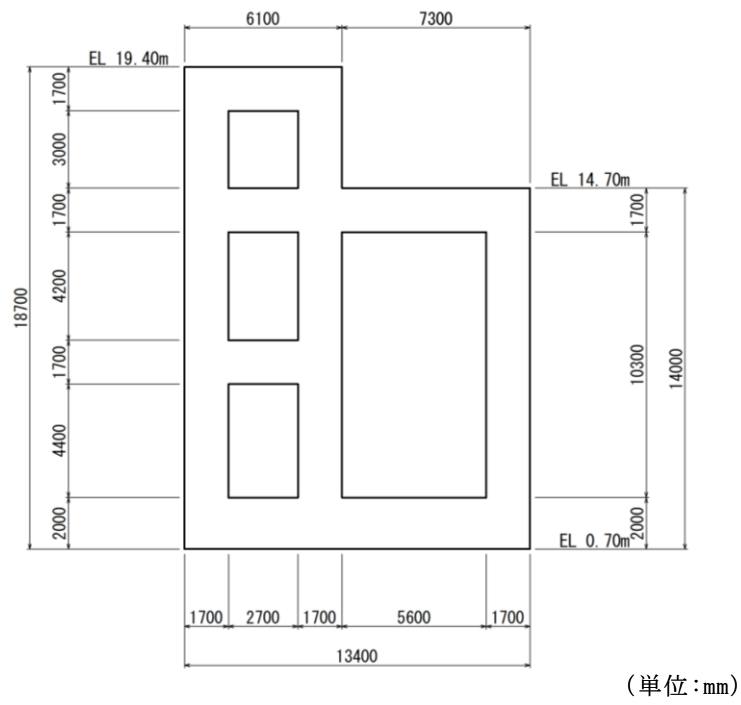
第 1 ベントフィルタ格納槽 断面図 (A-A 断面)
